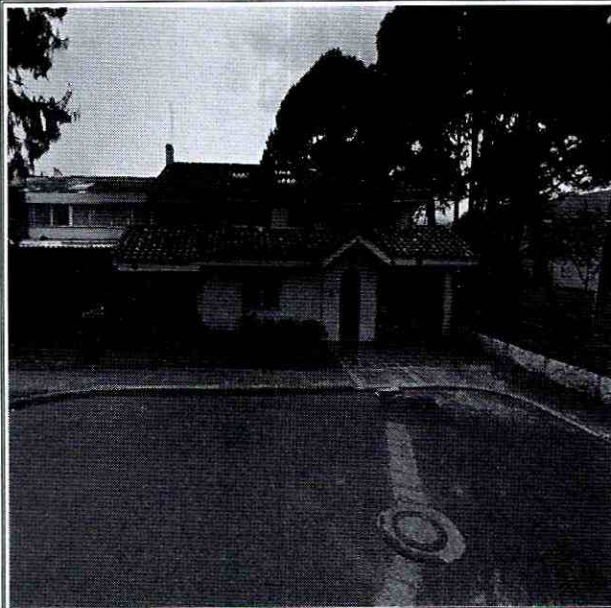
Vista frontal vivienda emplazada en el predio de la Carrea 70 H No. 122 - 08
